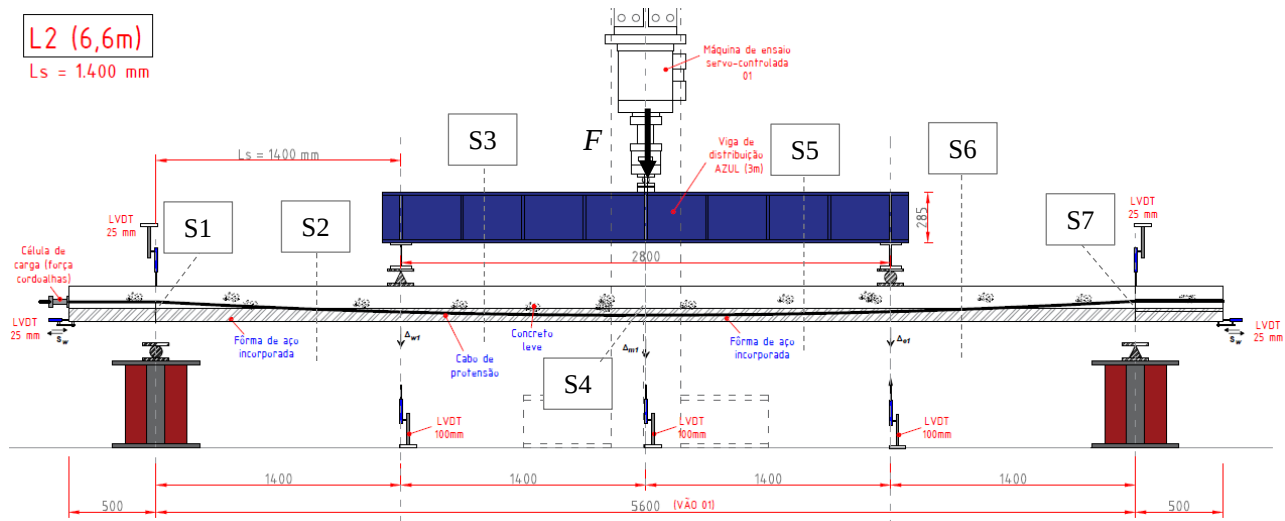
Protótipo experimental da laje mistas protendida LMP-02 junto ao pórtico 01 no ensaio de flexão a quatro pontos
